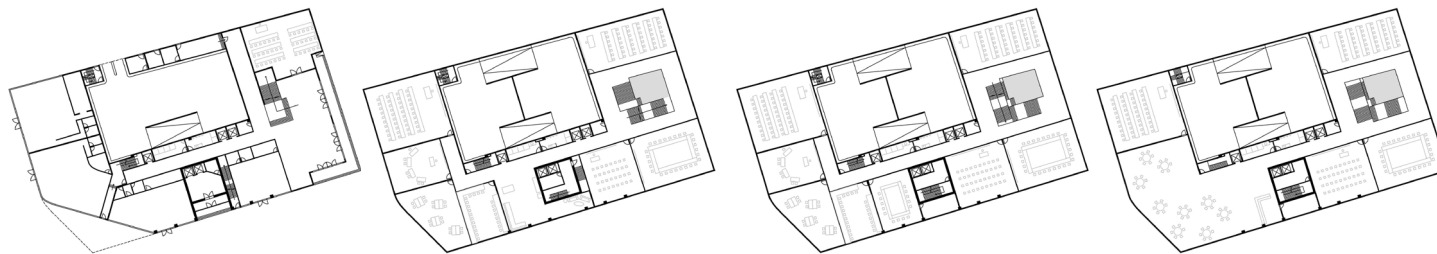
Grundrisse der Hochschule EG-3.OG (v.l.n.r.)
